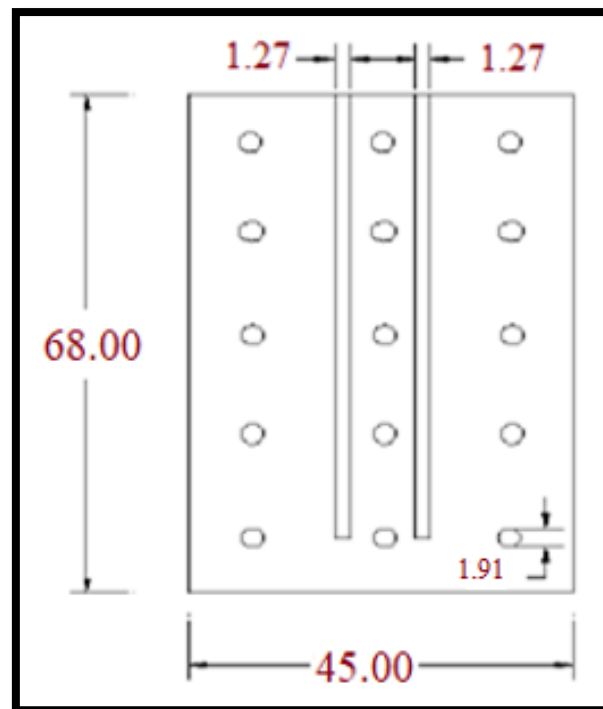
Vista en planta de la plancha metálica. Fuente: Propia
